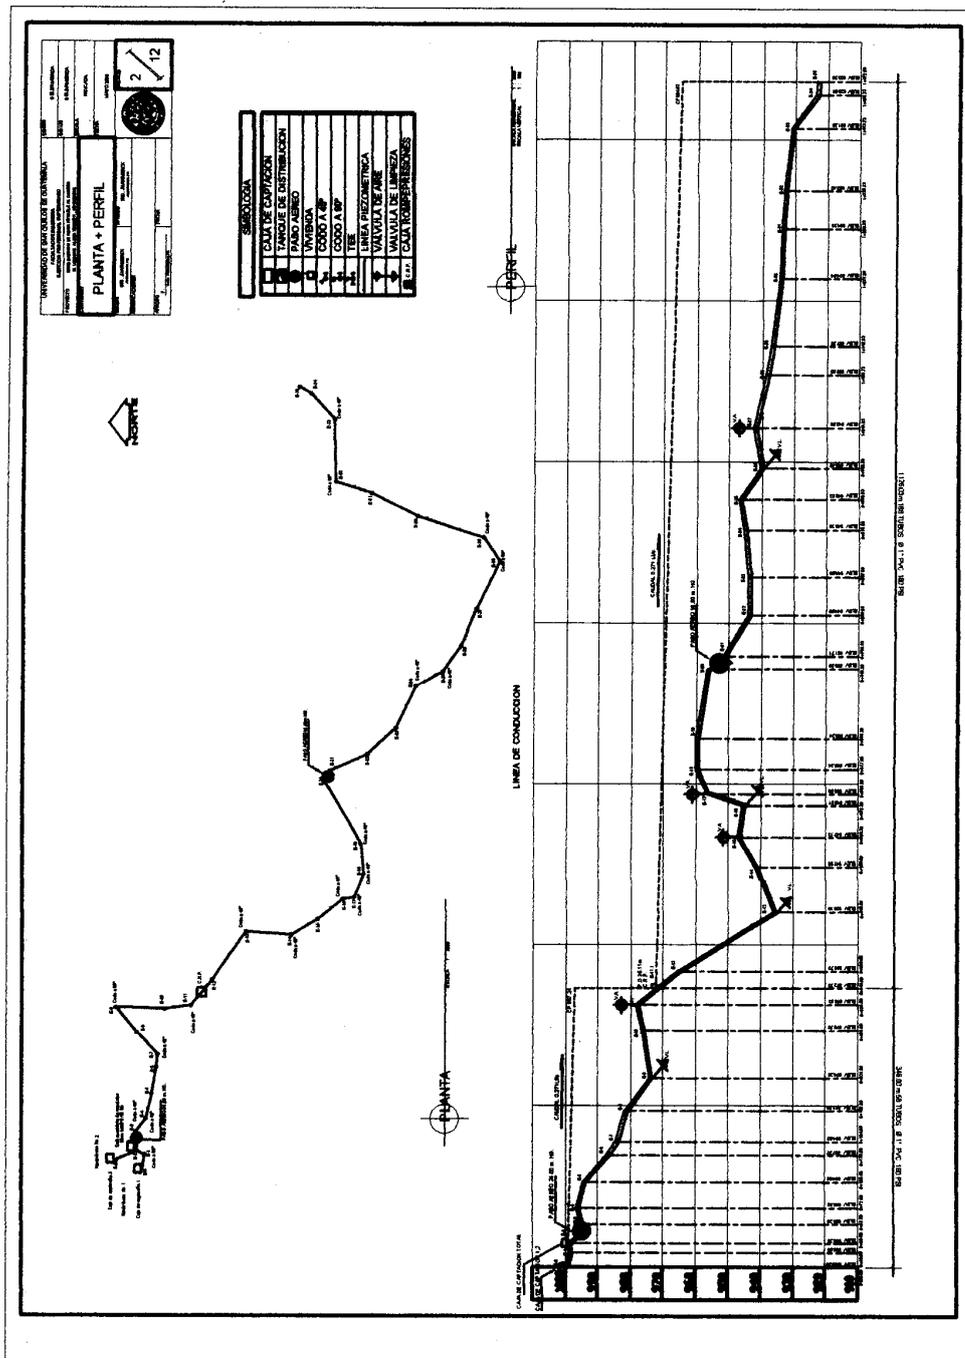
Planta perfil línea de conducción, de la estación E-35 a E-53
